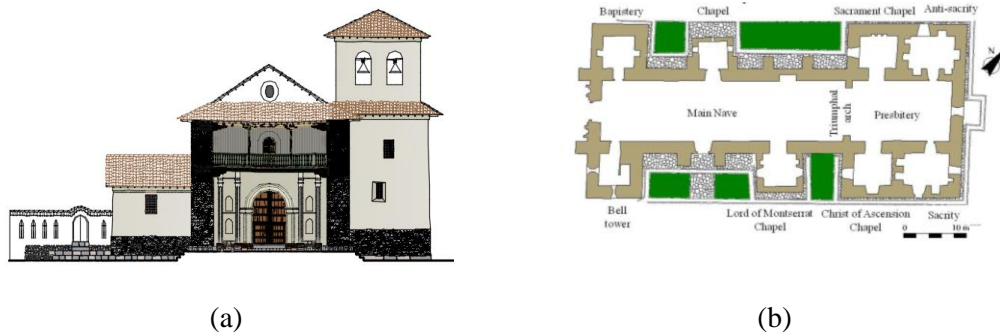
Iglesia San Pedro Apóstol, Planas Arquitectónicas (a) Plano Frontal; (b) Planta
